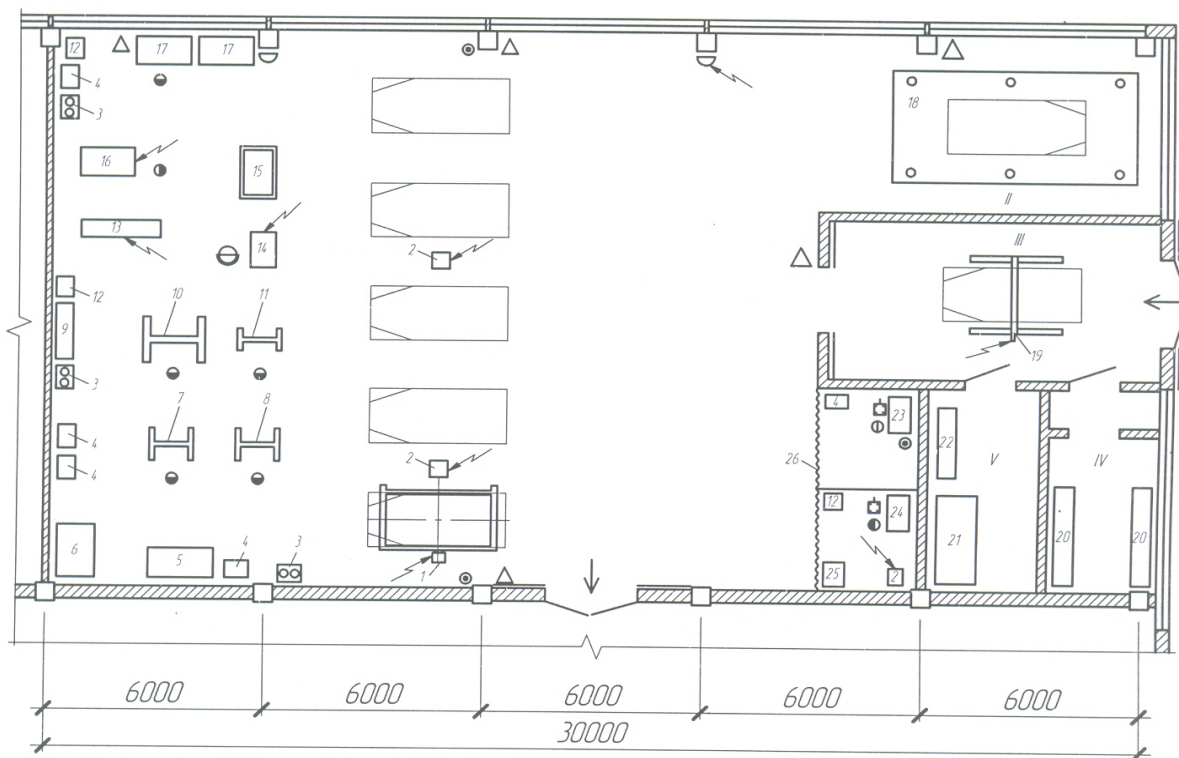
Сварочно-жестяницкий цех ПЦТО легковых автомобилей:
